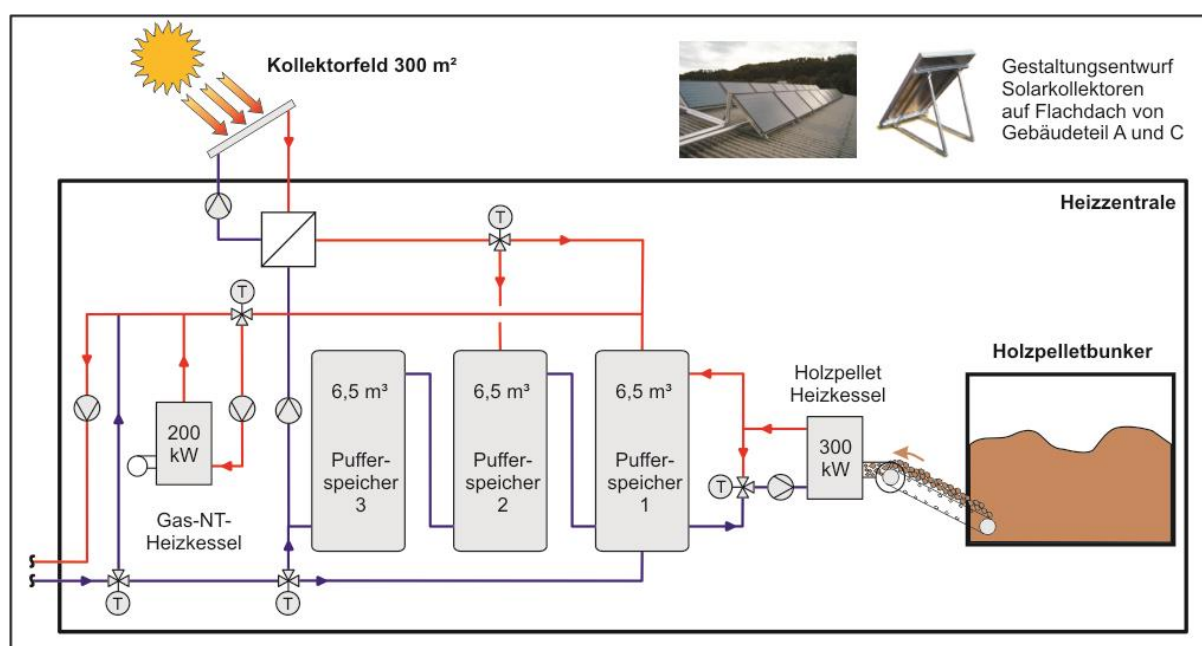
Anlagenschema Variante 3 – Holzpelletkessel mit Solaranlage 300 m²
